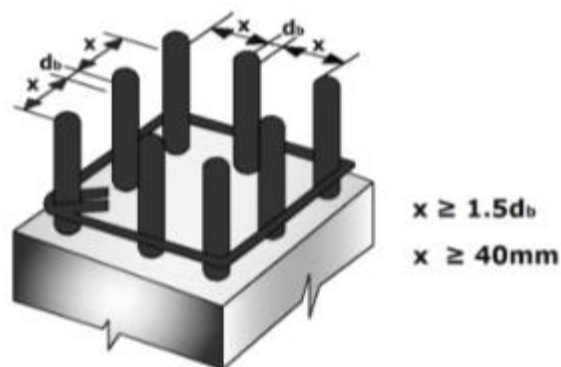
Distancia libre entre barras longitudinales en columnas
